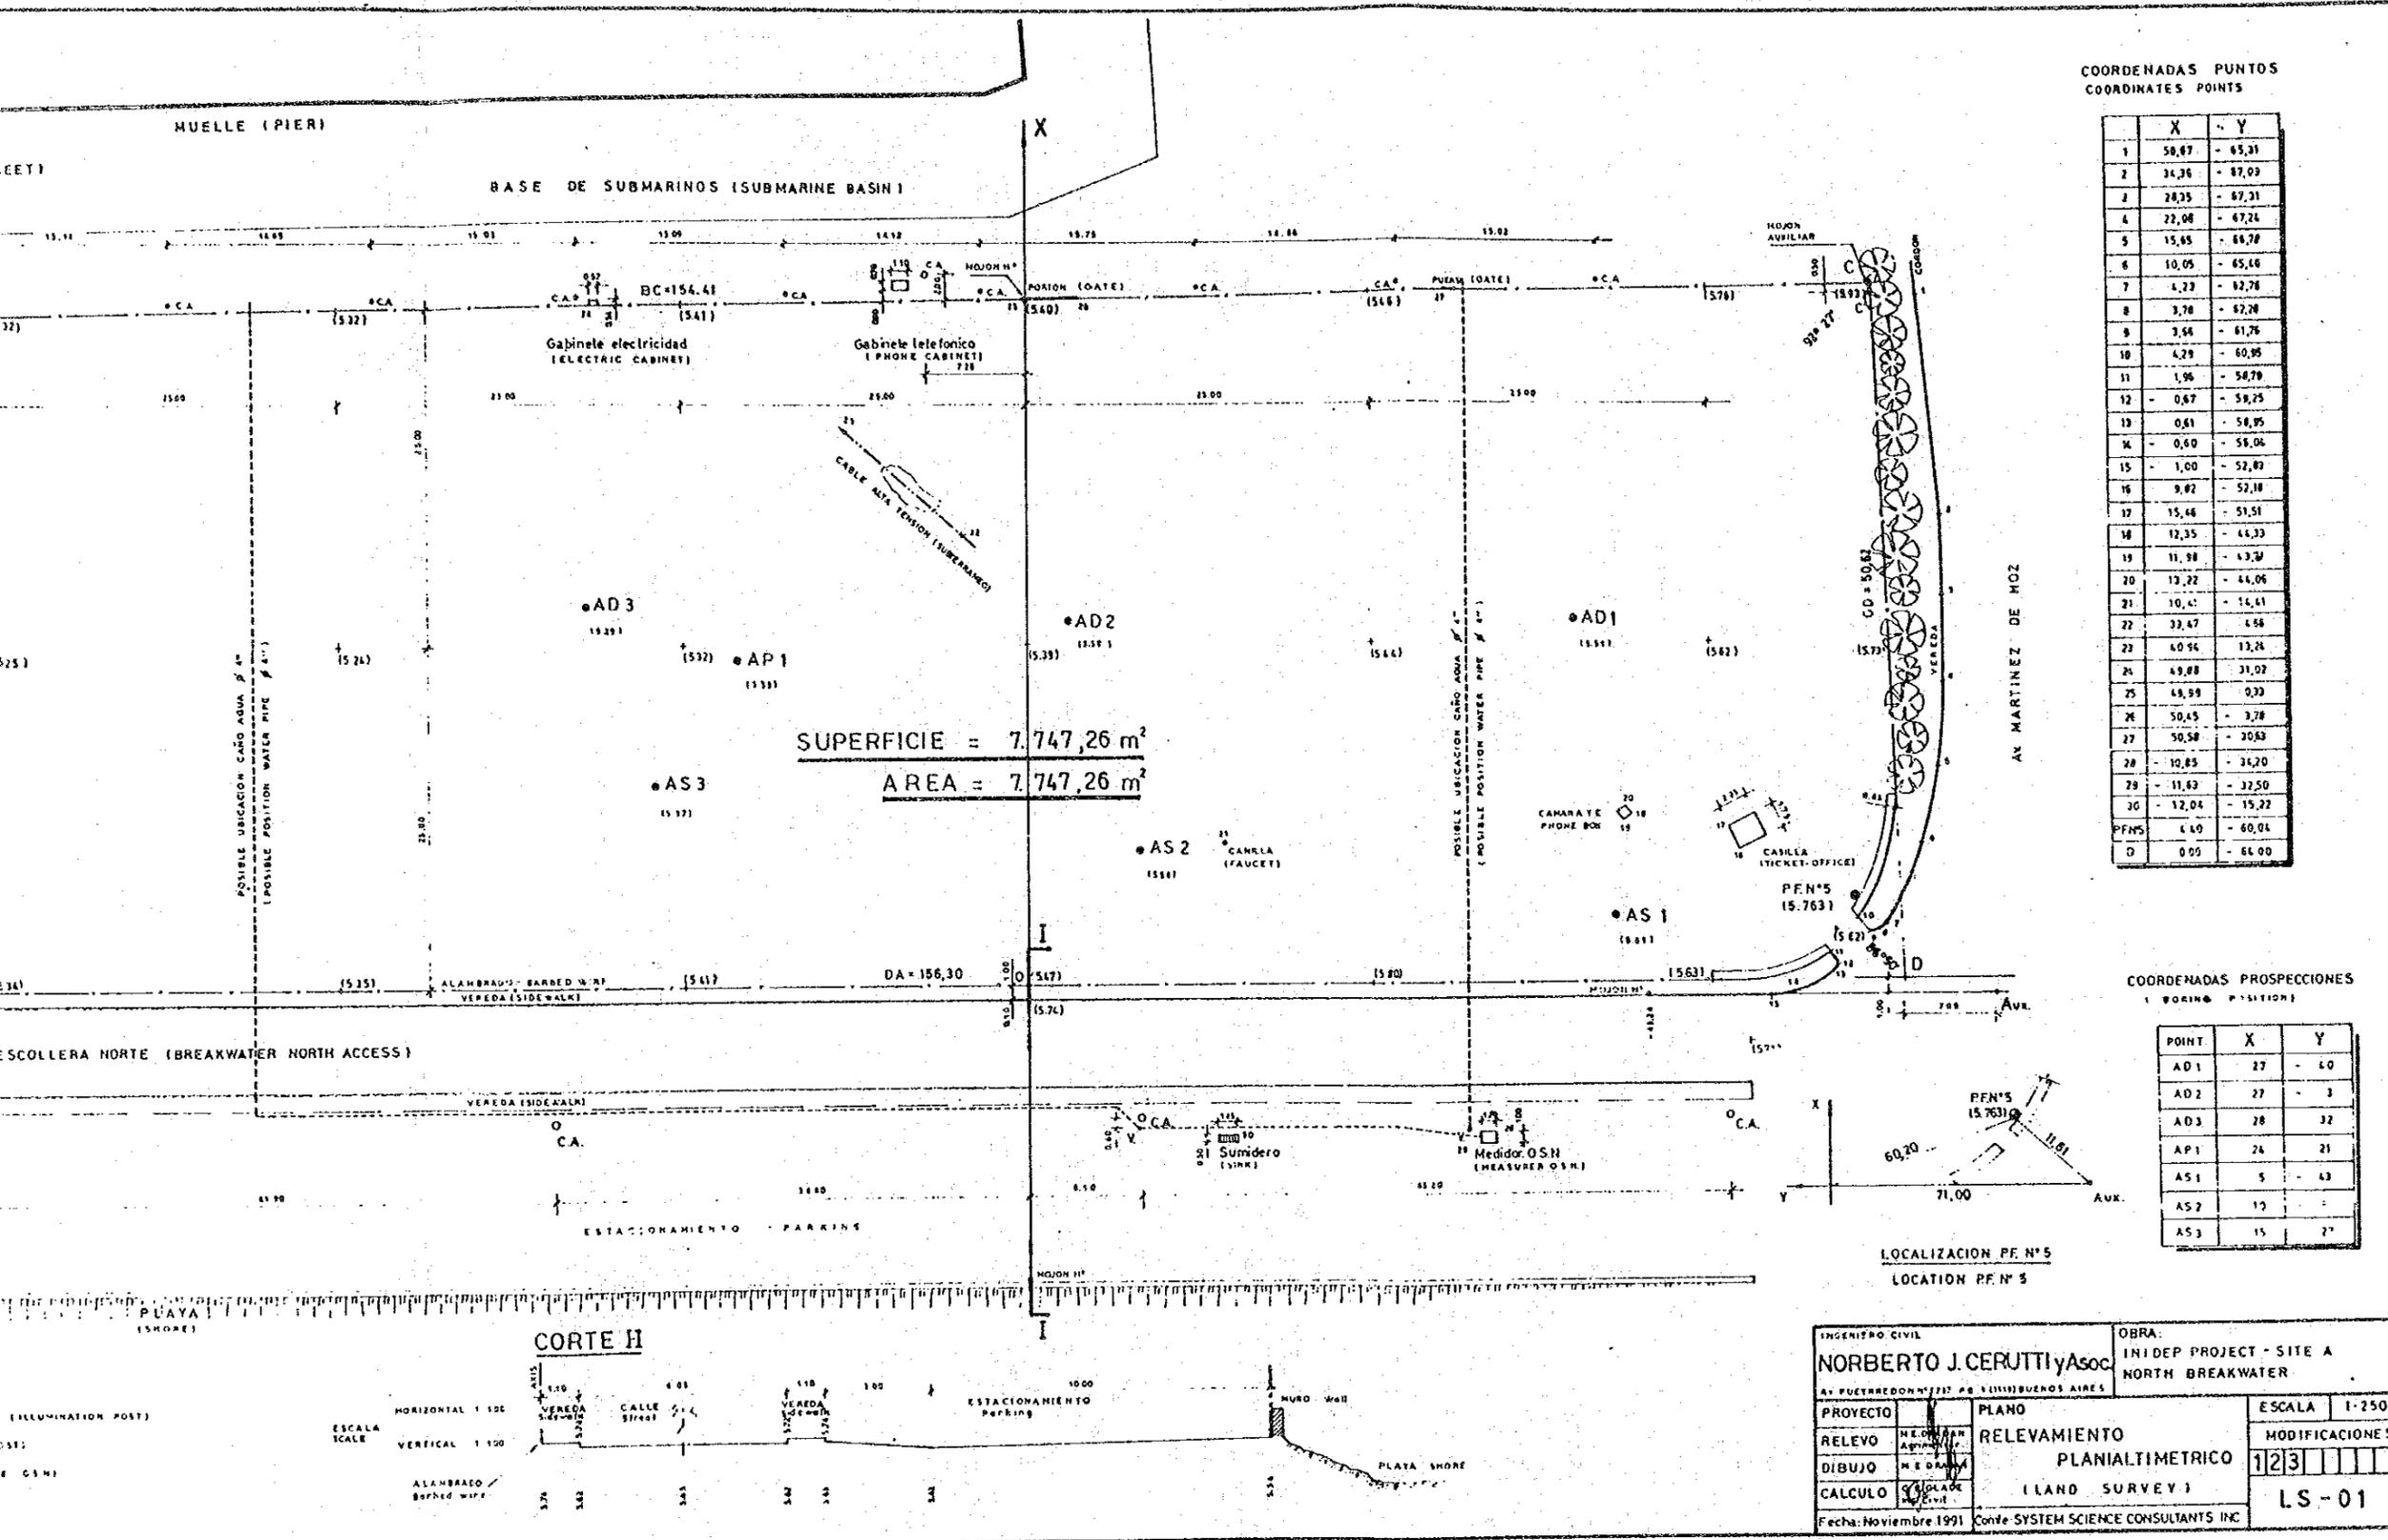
Plano de relevamiento planialtimétrico del sitio proyectado para construcción (Sitio A)
